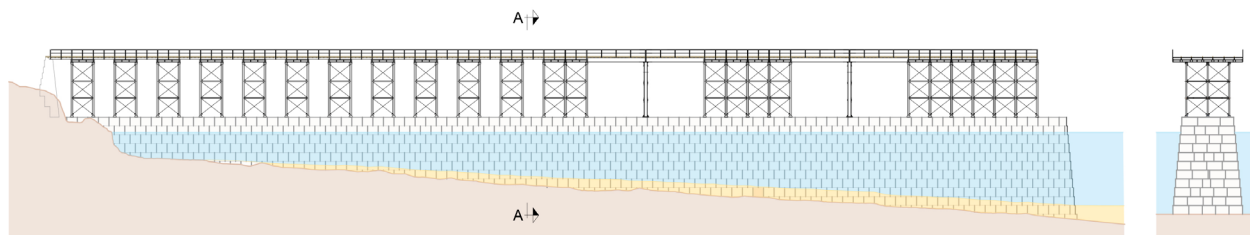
Alzado y sección del Embarcadero de El Hornillo
